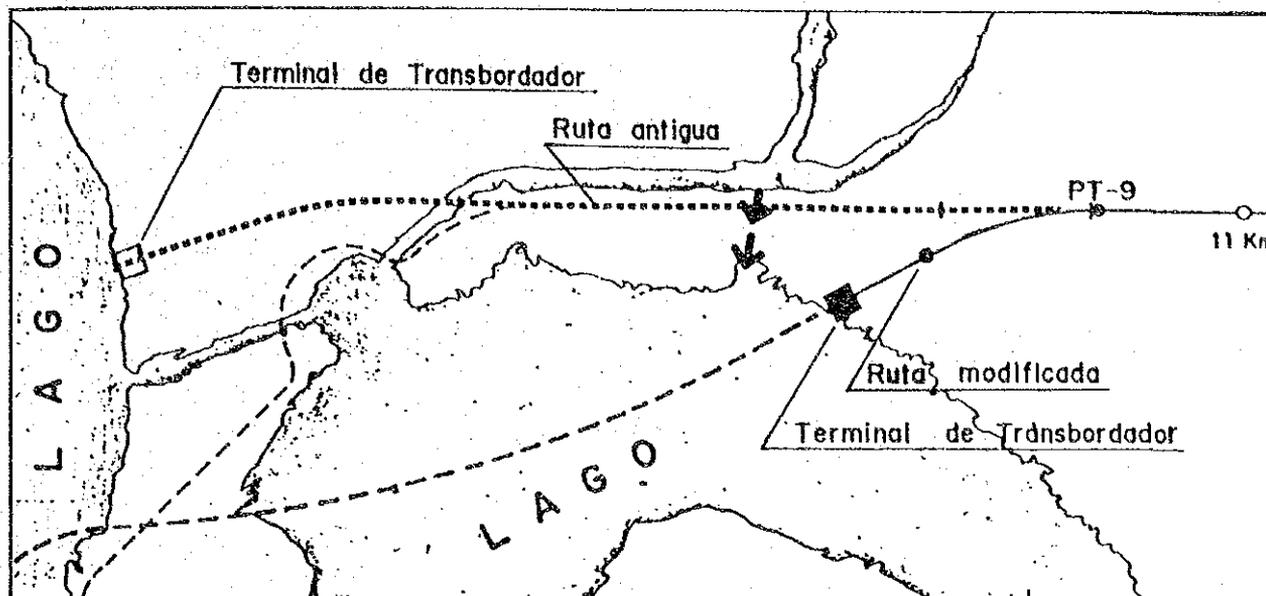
Modificación de la ubicación de la terminal de Transbordadores.
